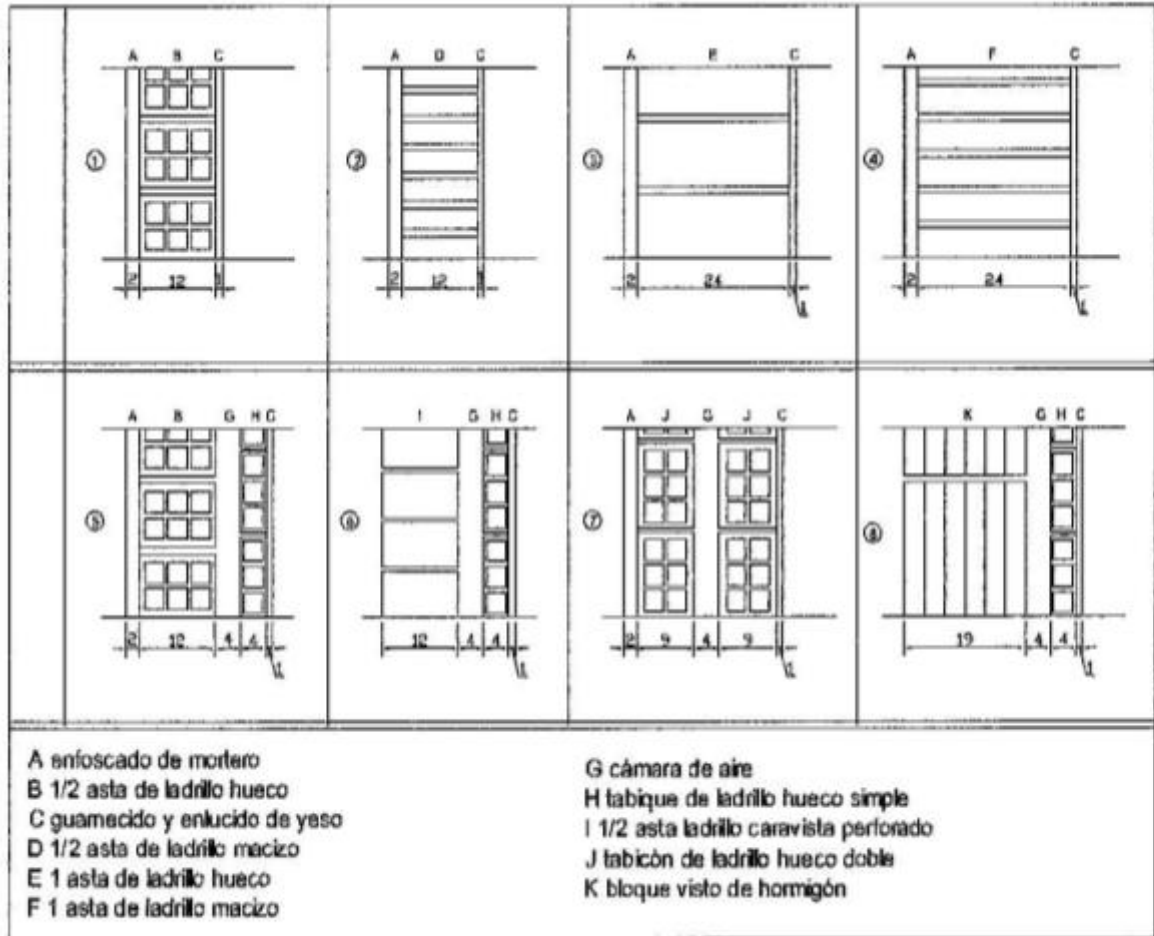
Tipología de fachadas construidas antes de la aparición de la NBE-CT-79
